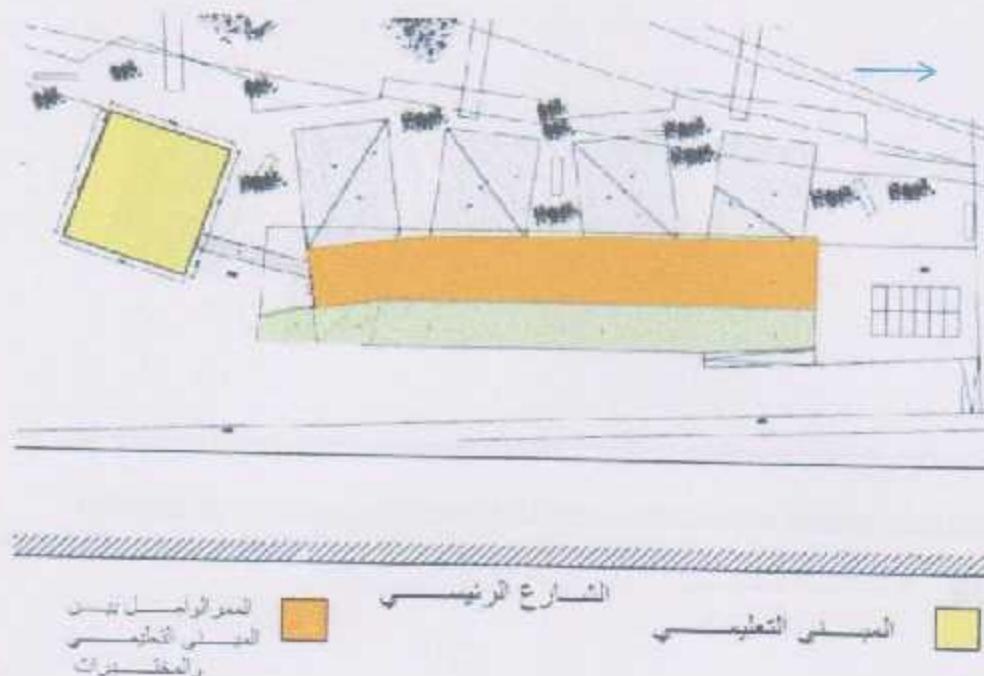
تحليل مسقط الطابق الأرضي
